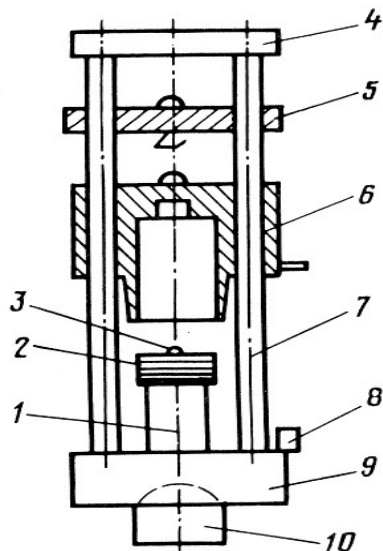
Схема штангового дизель-молота: 1 – поршень; 2 – компресійне кільце; 3 – форсунка; 4 – траверса; 5 – захватний пристрій – "кішка"; 6 – молот-циліндр; 7 – штанга; 8 – паливний насос високого тиску; 9 – ковадло, 10 – наголовник палі
